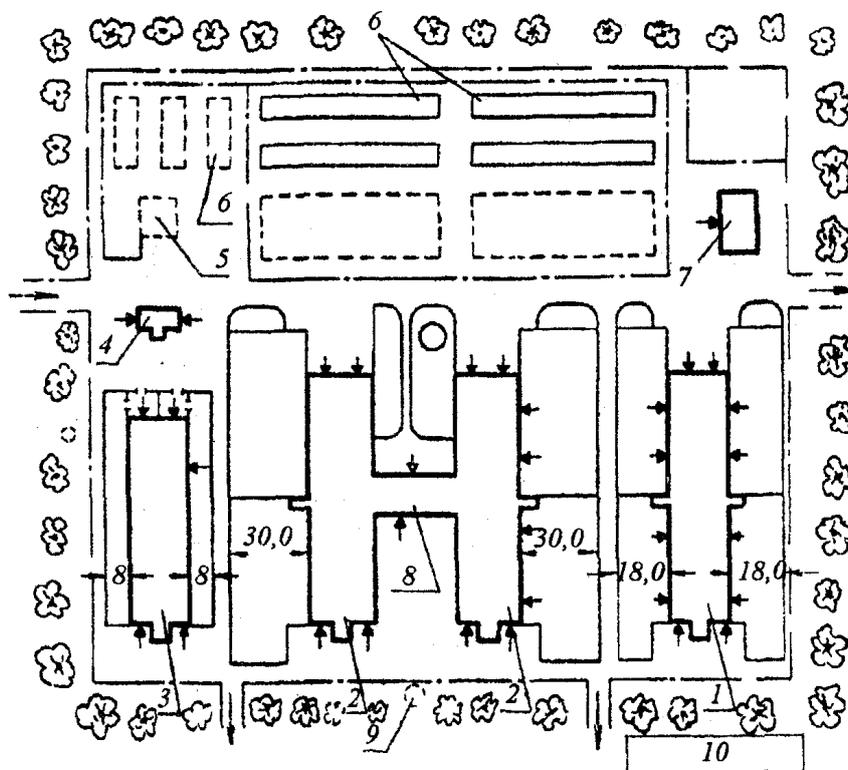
Генеральный план фермы на 400 коров привязного содержания:
